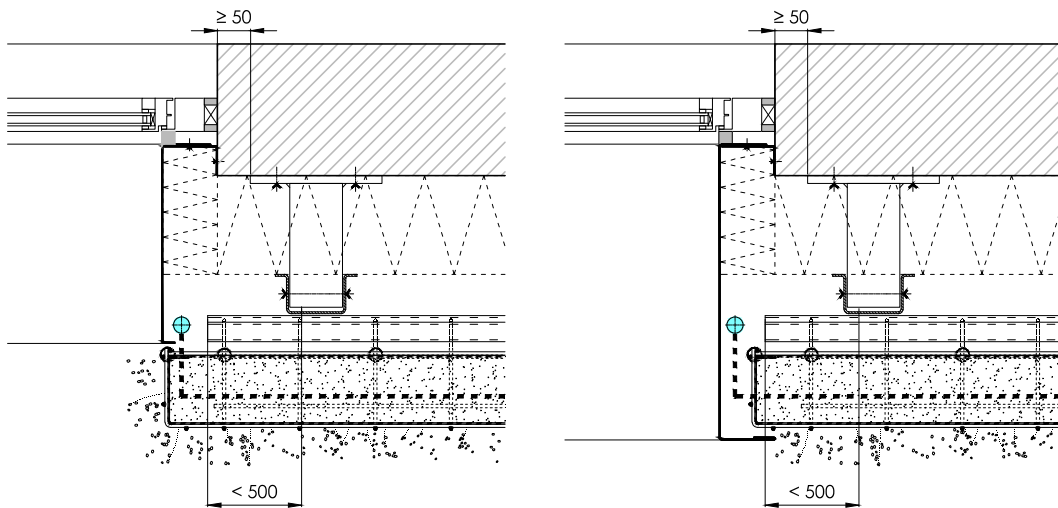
Jonction avec tableau de baie - Fixation au support par consoles
